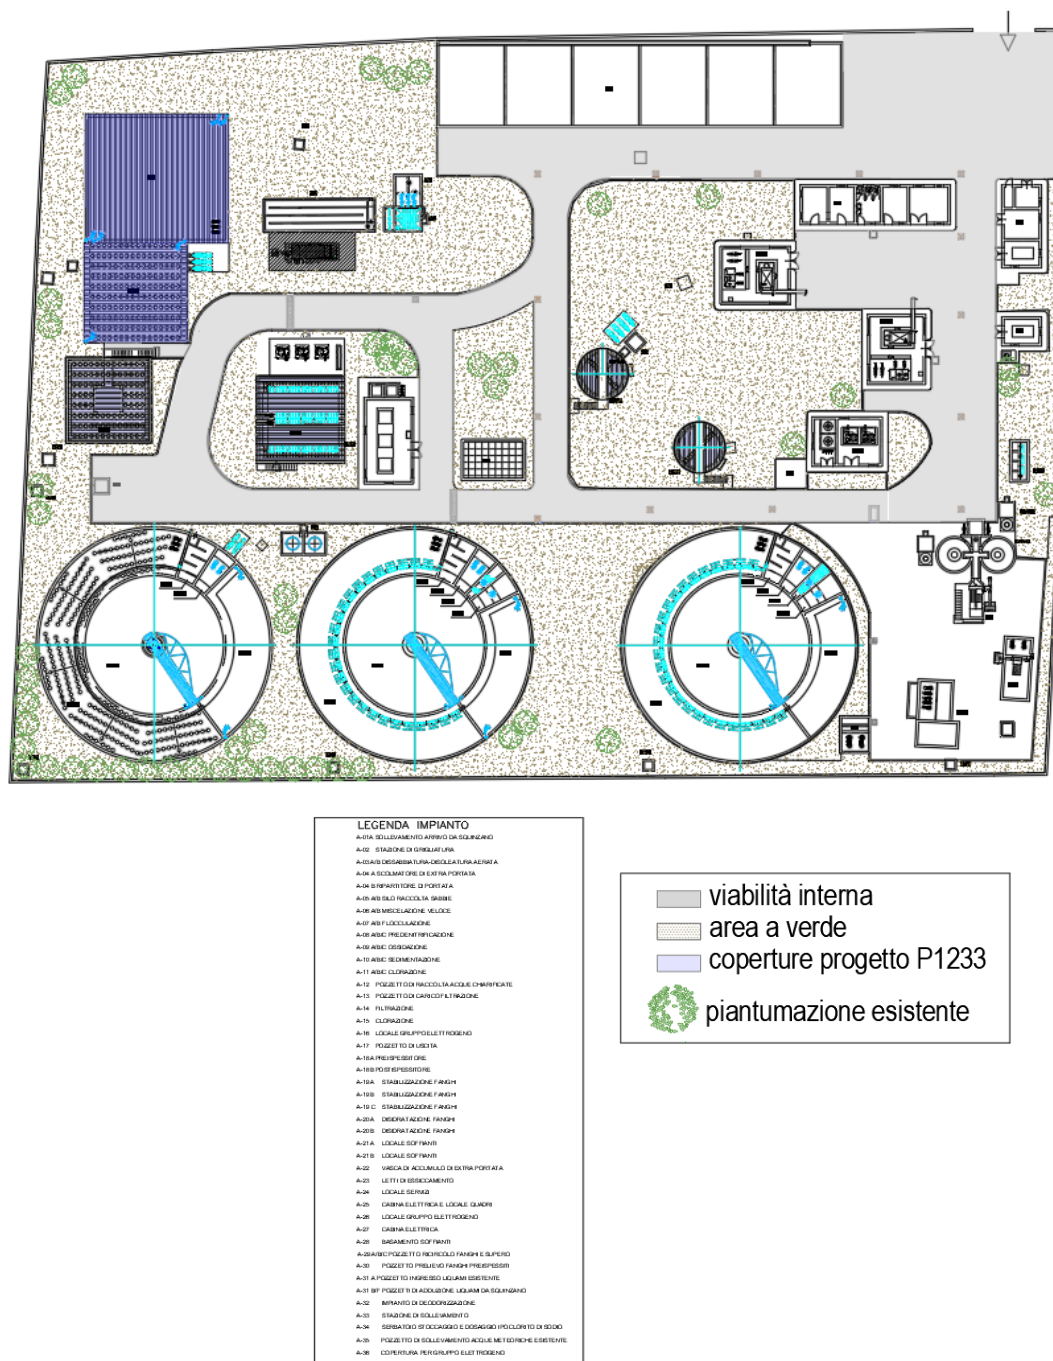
Planimetria esistente – Impianto di depurazione Squinzano
